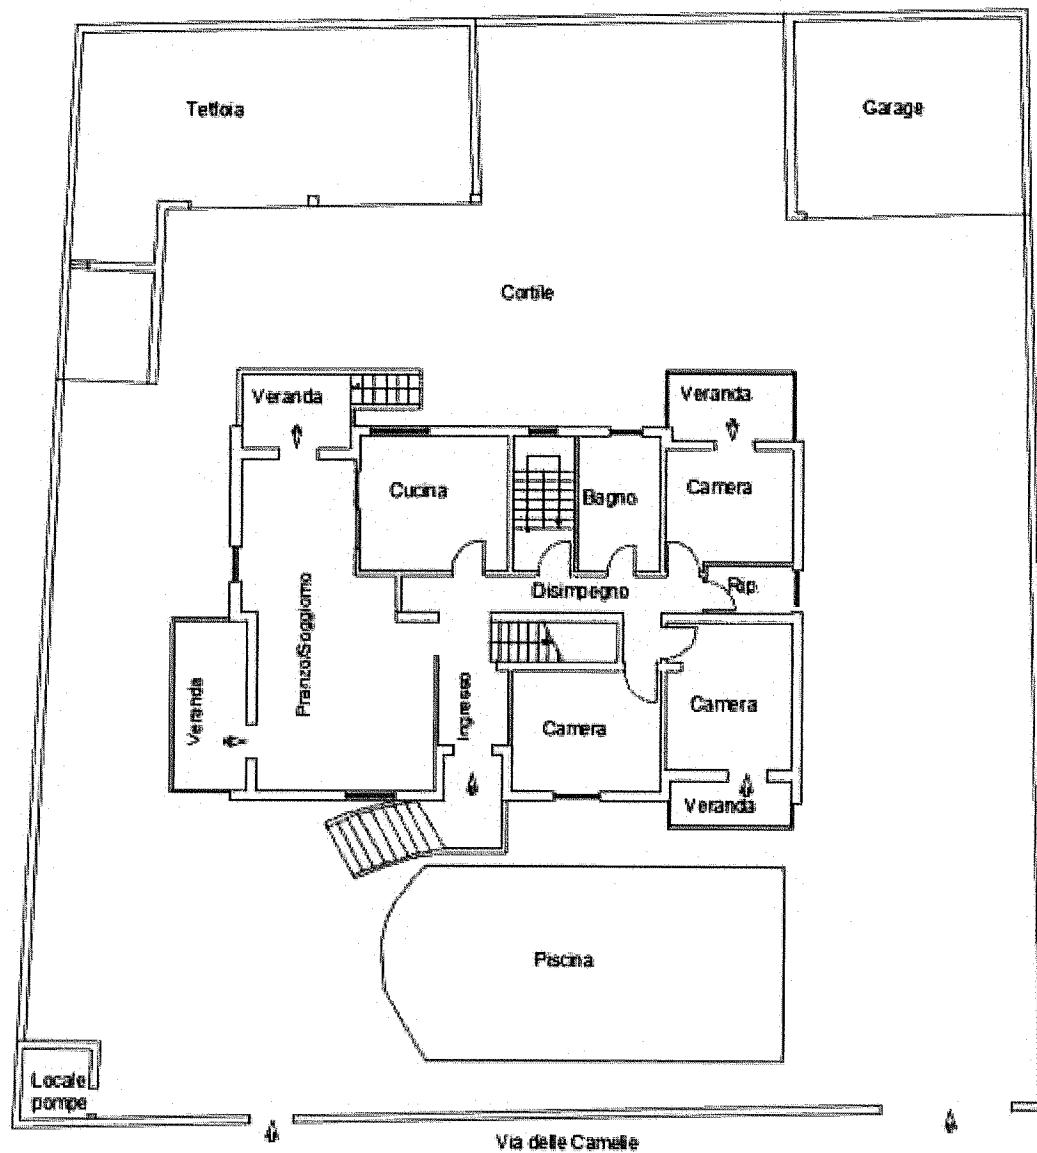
Planimetria Piano Terra – Situazione esistente
